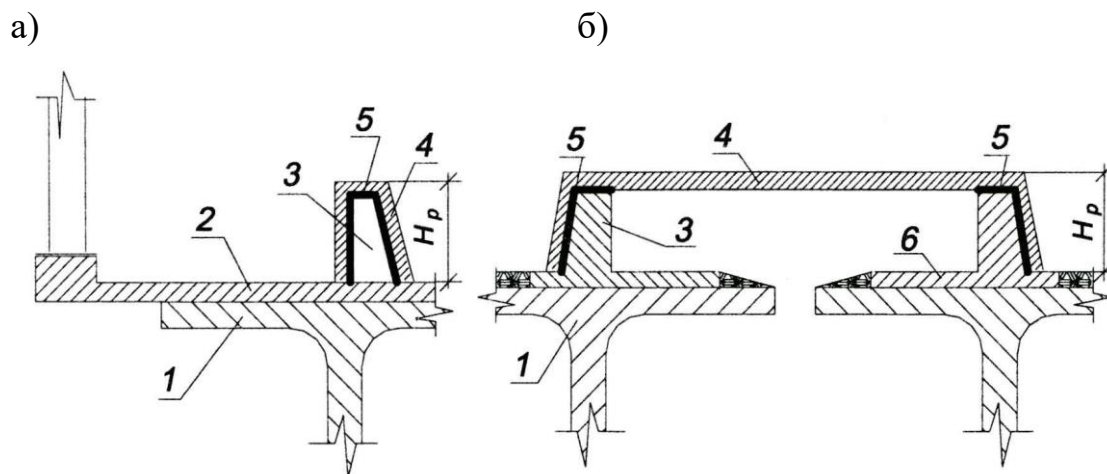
Наращивание парапета при помощи железобетонной «рубашки»
